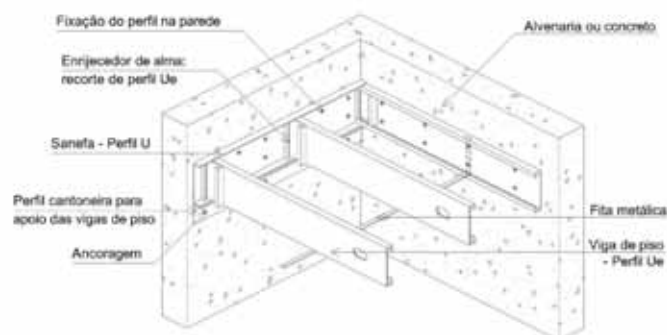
Laje em Light Steel Framing apoiada sobre estrutura tradicional.
